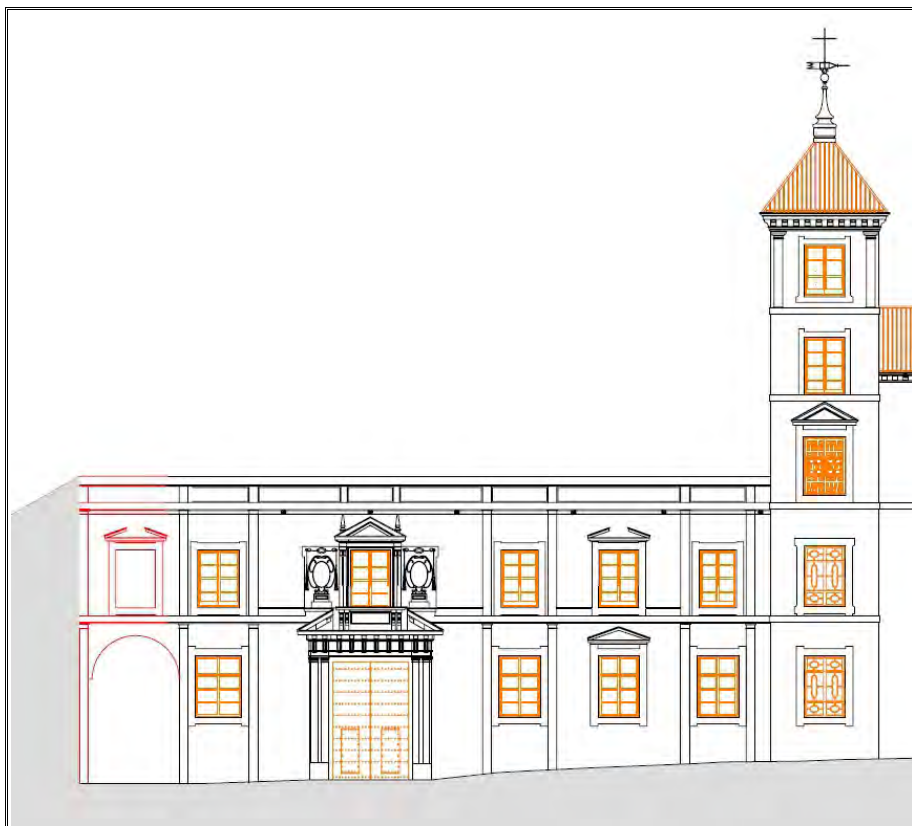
Reconstrucción del alzado de la fachada este del Palacio, antes de 1864, con el Arco de Guía. (OAFJ).
